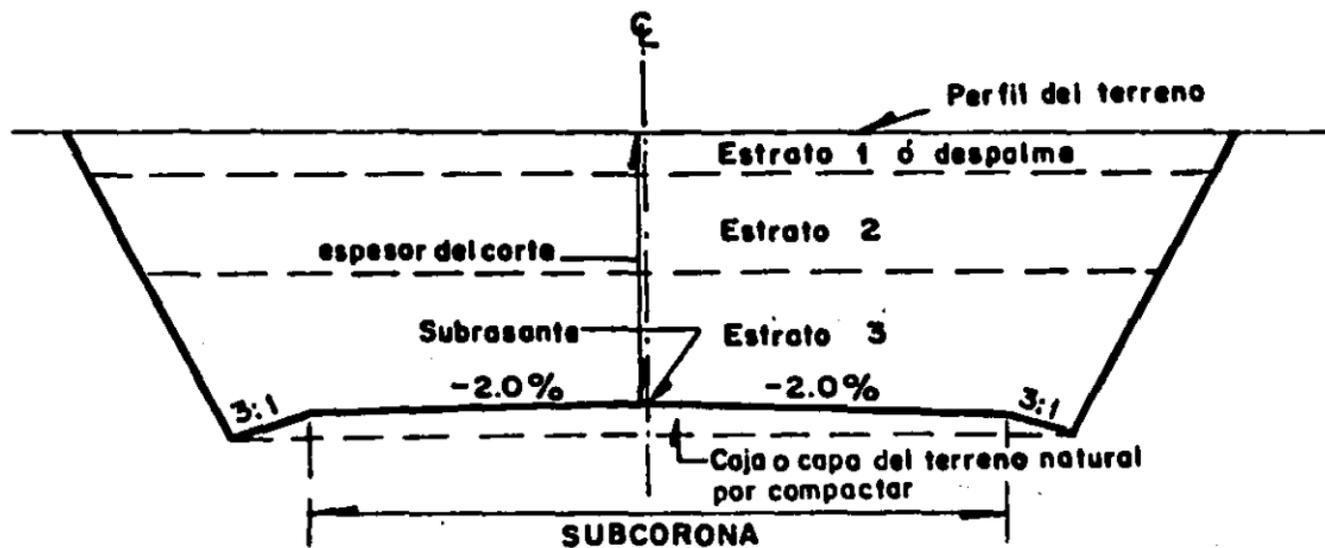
SECCION DE CONSTRUCCION DE UN CORTE EN TANGENTE
